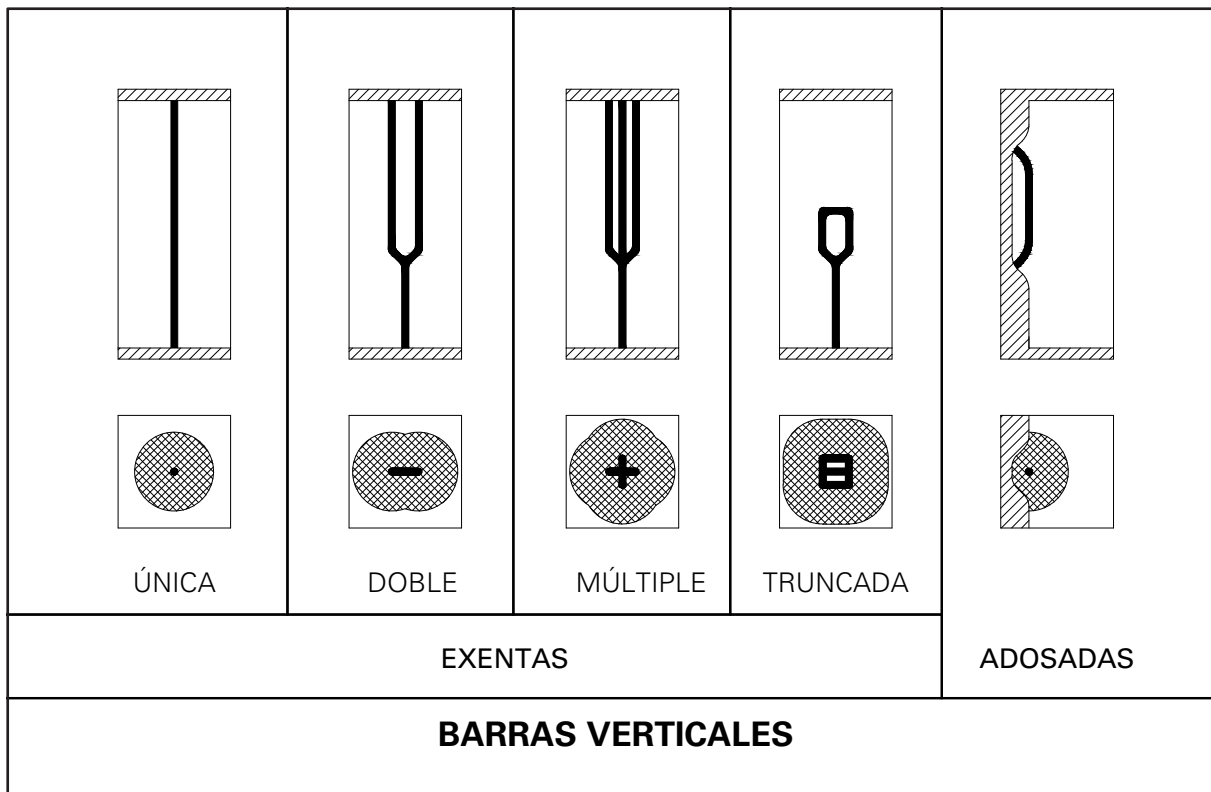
Tipos de barras verticales; en la vista de planta se pueden comparar las zonas de servicio.
